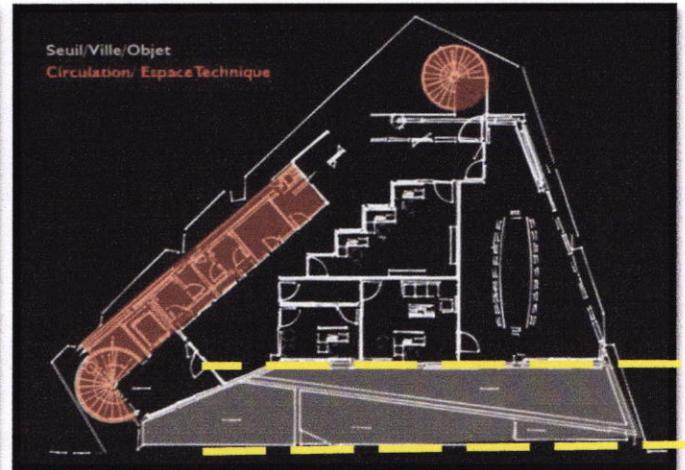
schéma plan étage de l'historial (façade épaisse).
